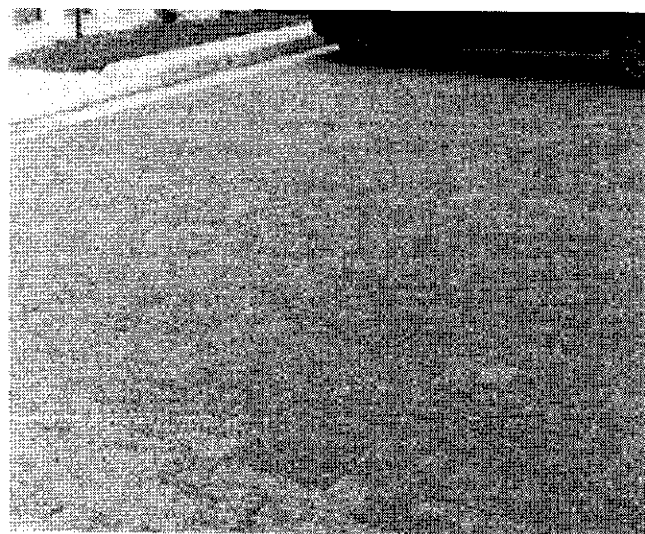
Pavimento Intertravado Permeável com peça de concreto poroso
